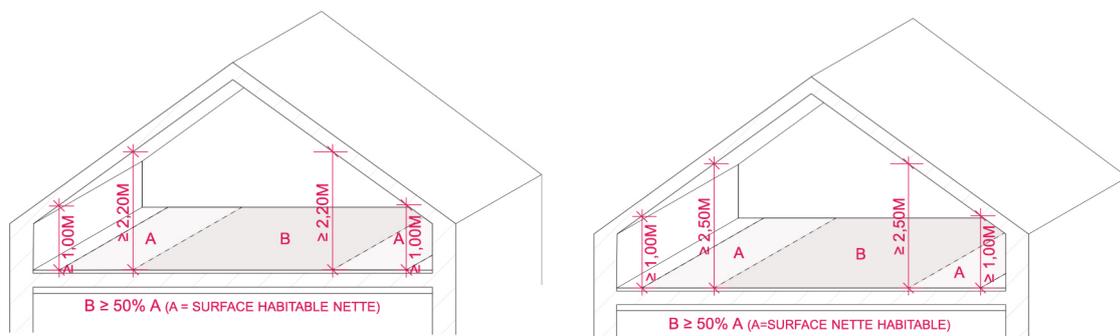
Hauteur libre sous plafond des combles - constructions existantes et nouvelles
